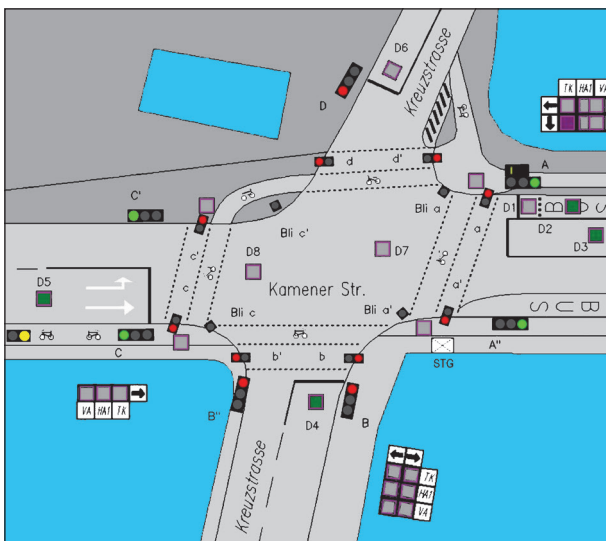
Signallageplan des Knotenpunkts Kamener Straße/ Kreuzstraße in Lünen
